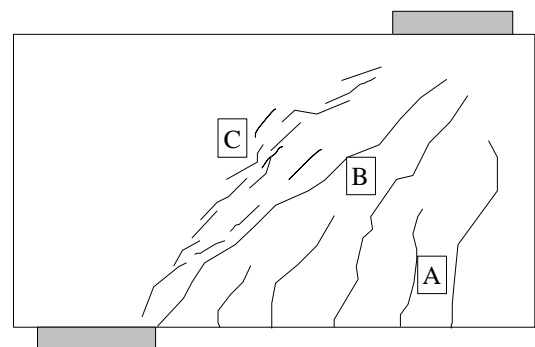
試験体 No.5 のひび割れ進展状況
